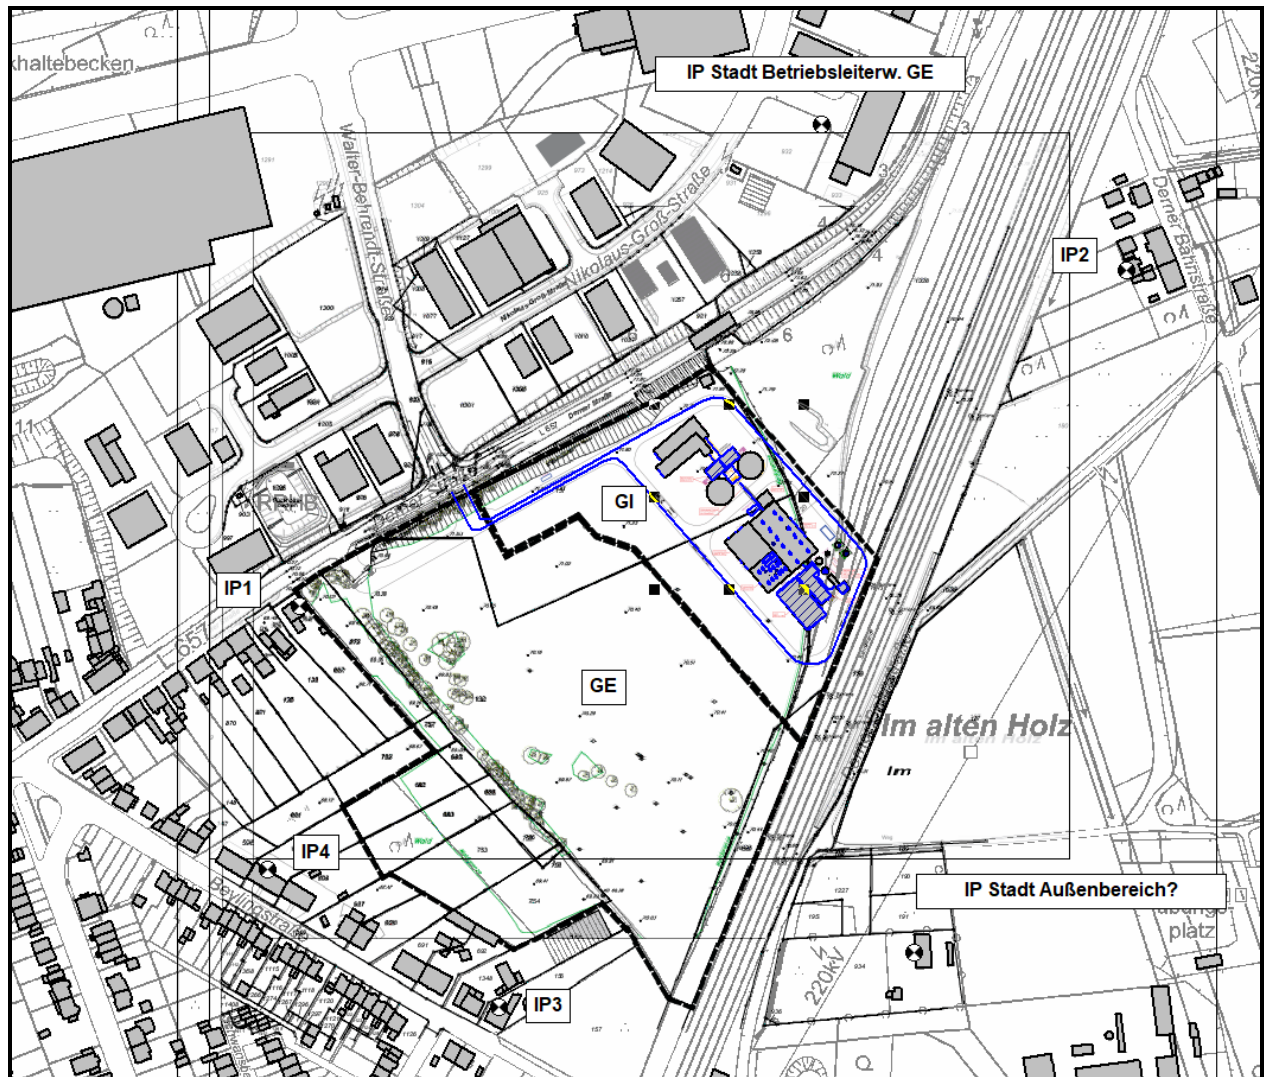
Übersichtsplan mit Planstand Kraftwerk
